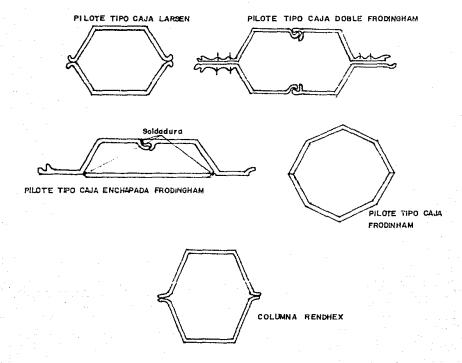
SECCIONES TRASVERSALES DE PILOTES TIPO CAJA.
